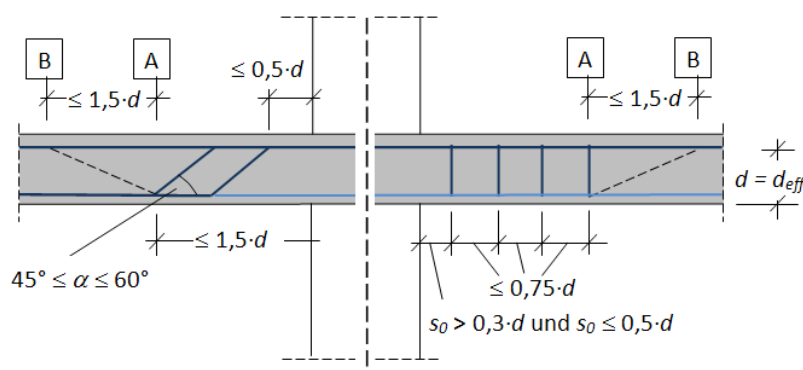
Anordnung der Durchstanzbewehrung bei Flachdecken
